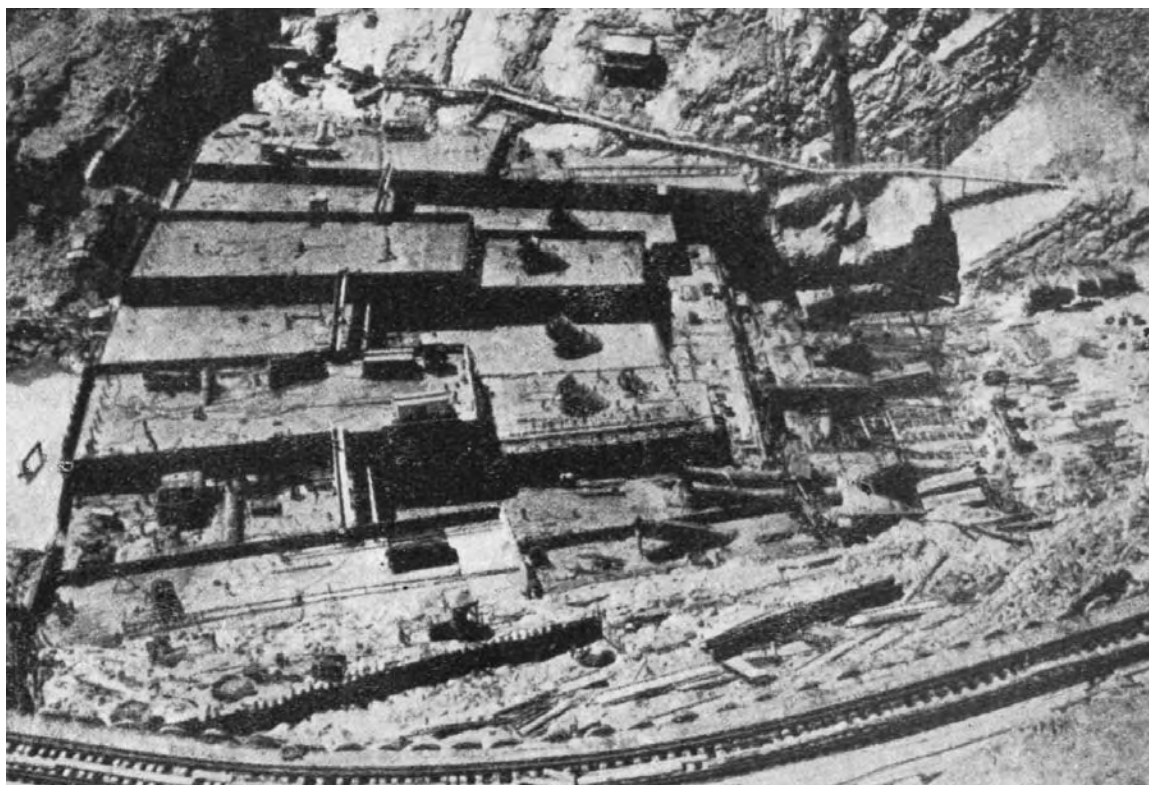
Vista parcial de la presa Hungry House, en construcción.
